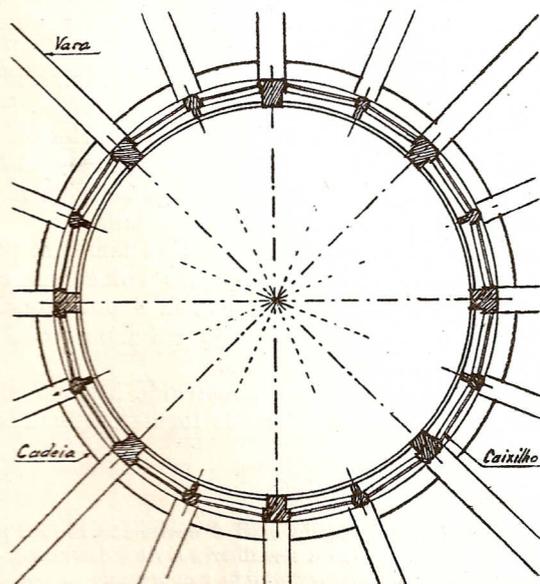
PLANTA DA ARMAÇÃO DO LANTERNIM
